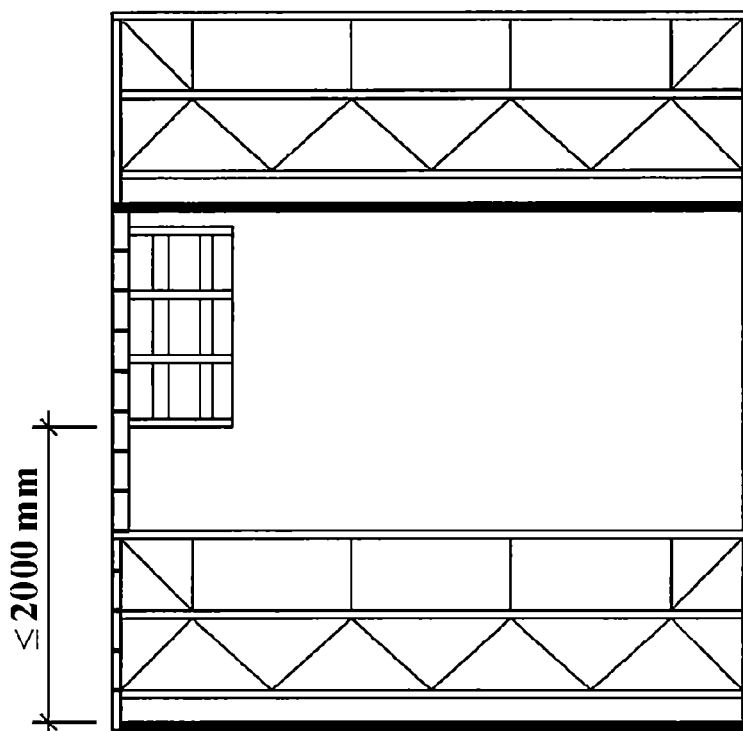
Dispositivo de protección para la plataforma de suelos múltiples
